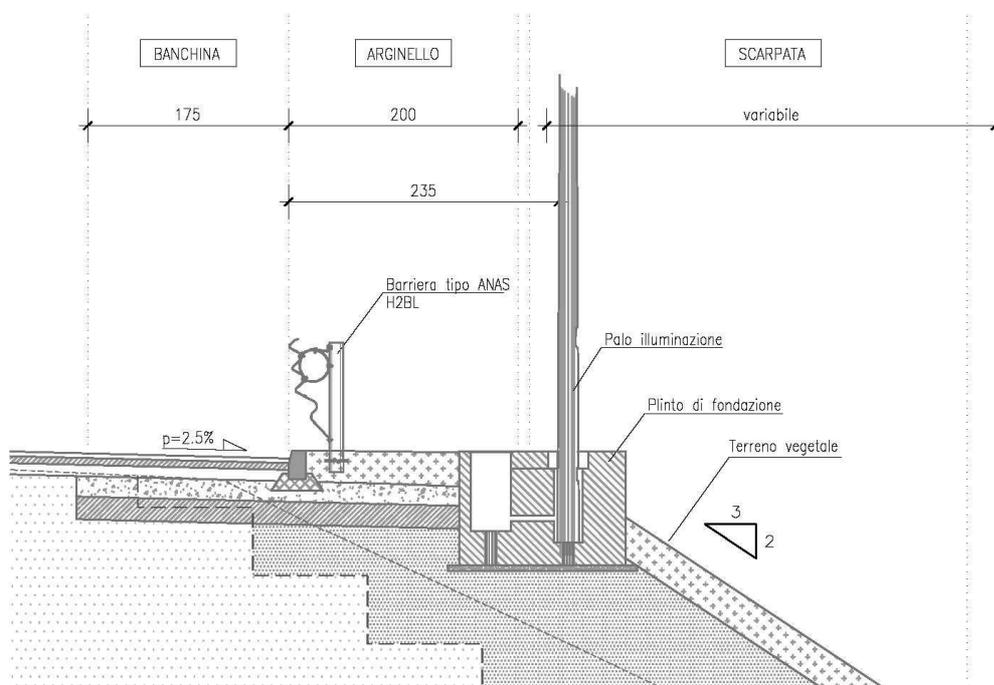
Protezione di progetto asse principale tratti bordo laterale in rilevato
